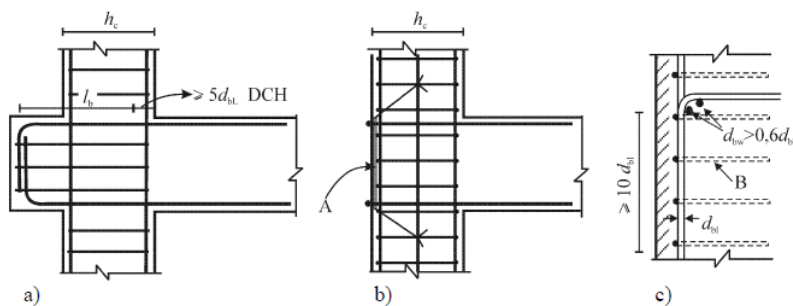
Disposições complementares para a amarração no nós viga-pilar exteriores [EC8]
